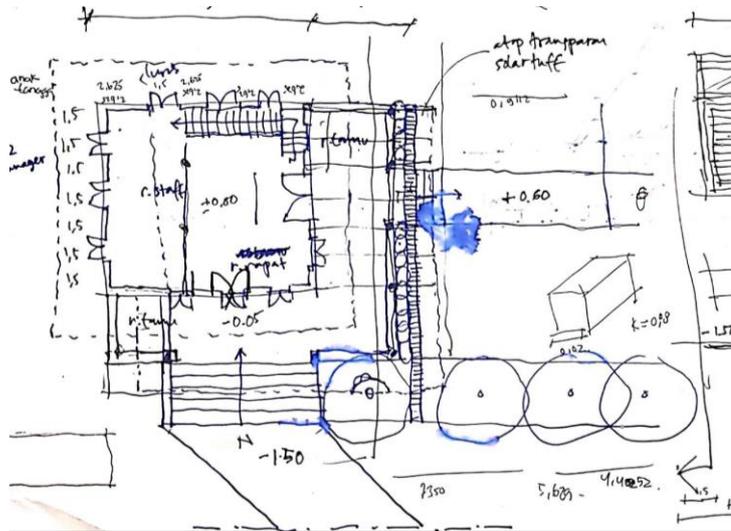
34. *Sketch Lagsung di Lapangan dan Montage
